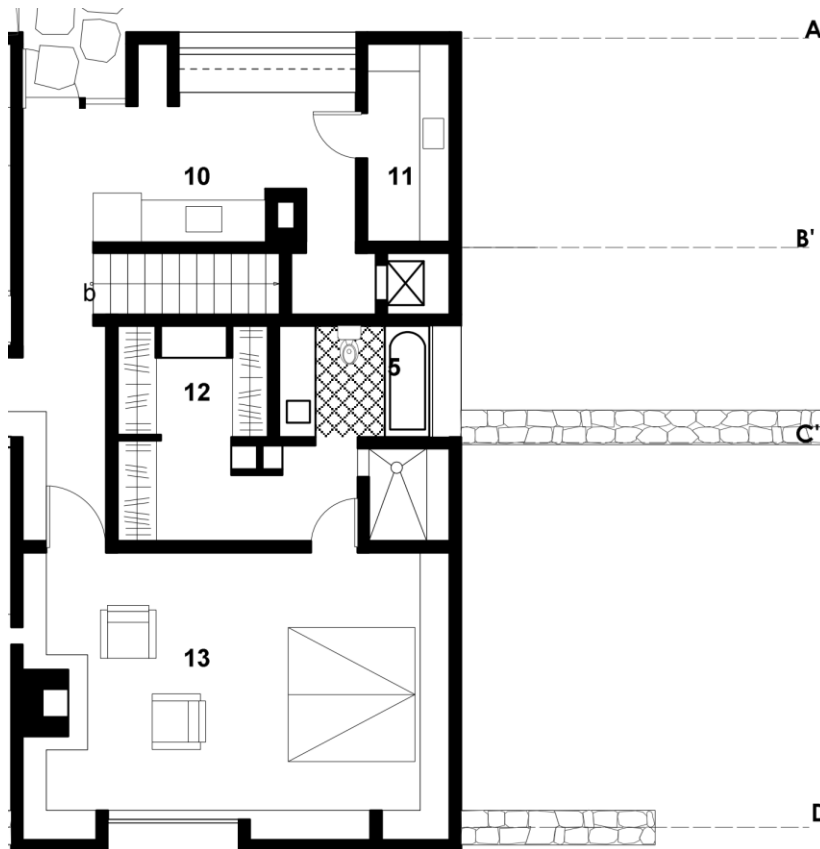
Planta baja, zonificación bloque 2. Fuente: Autor.
